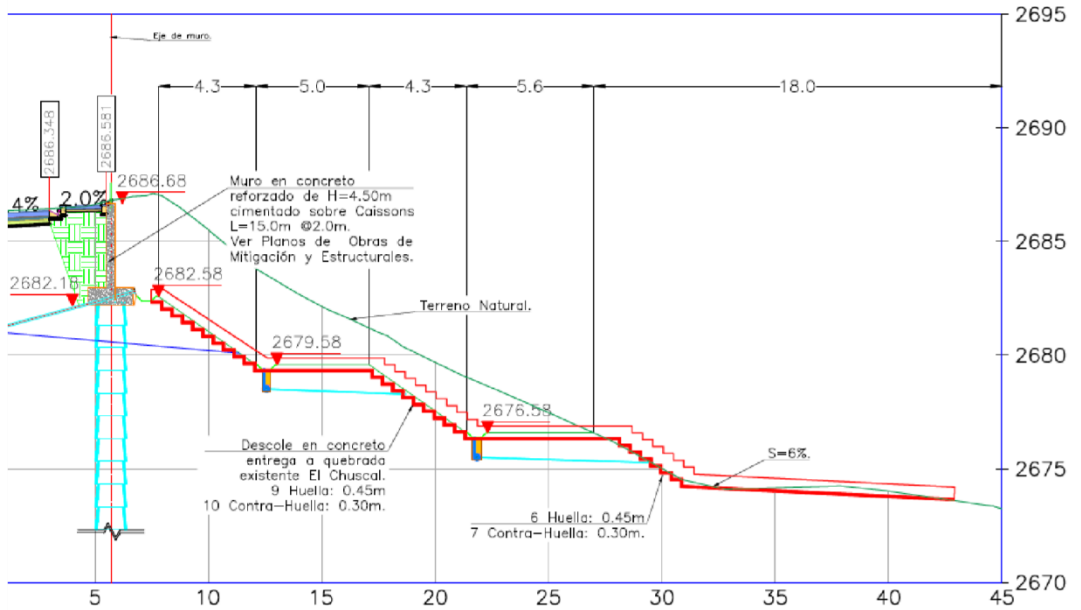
Detalles constructivos de las obras de estabilización y de la cuneta que finaliza en un descole a la quebrada El Chuscal.
